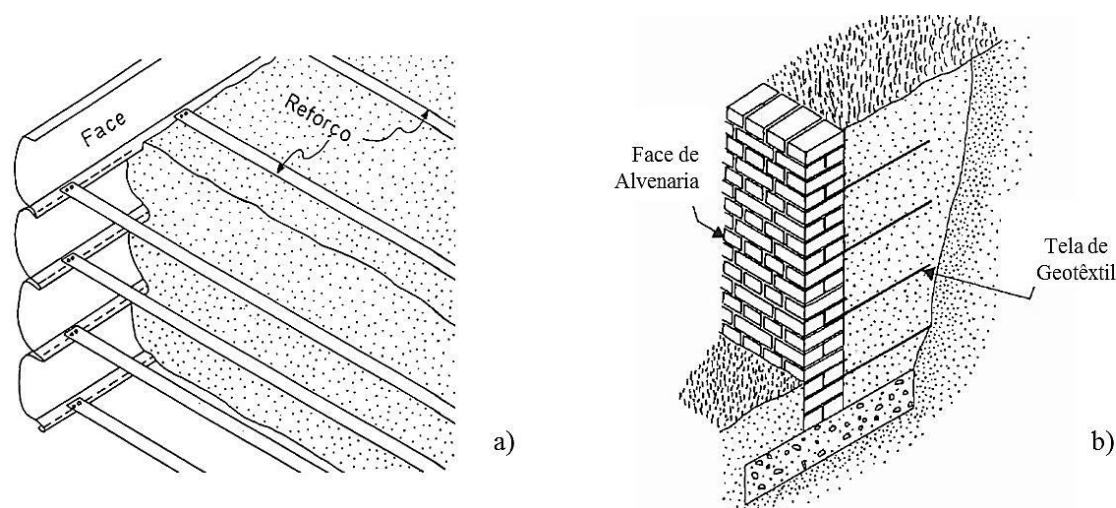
Esquema do muro a) de terra armada proposto por Vidal, em 1966 e b) proposto por Dalton, em 1977 (Pinto, 1992)
